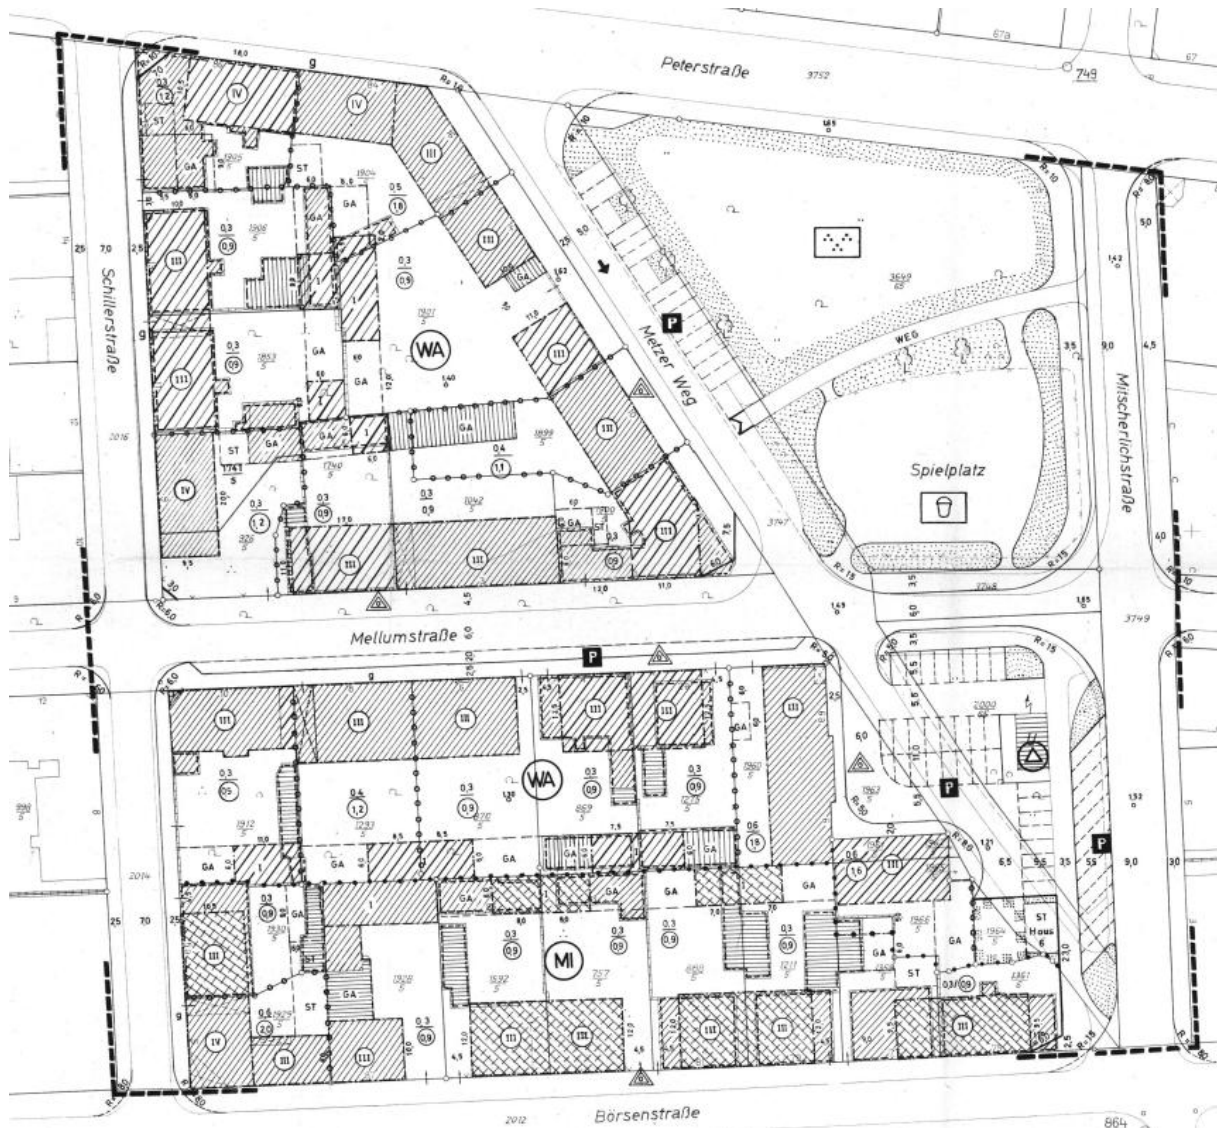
Bebauungsplan Nr. 11 - Metzer Weg / Mitscherlichstraße -
